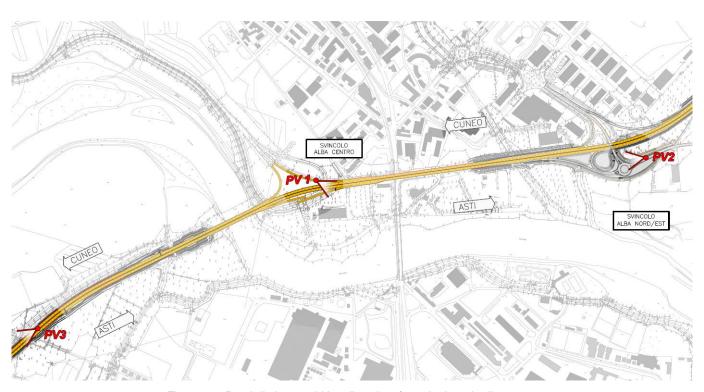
Punti di vista scelti localizzati su foto planimetria di progetto
